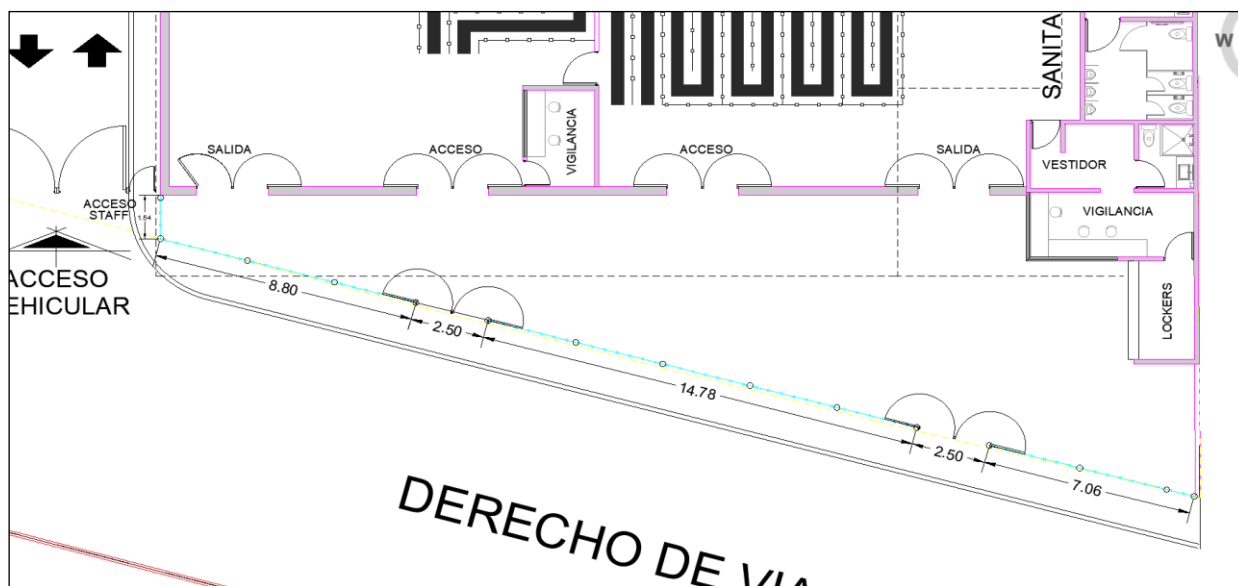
Espaciamiento de las puertas de herrería y reja frontal.
